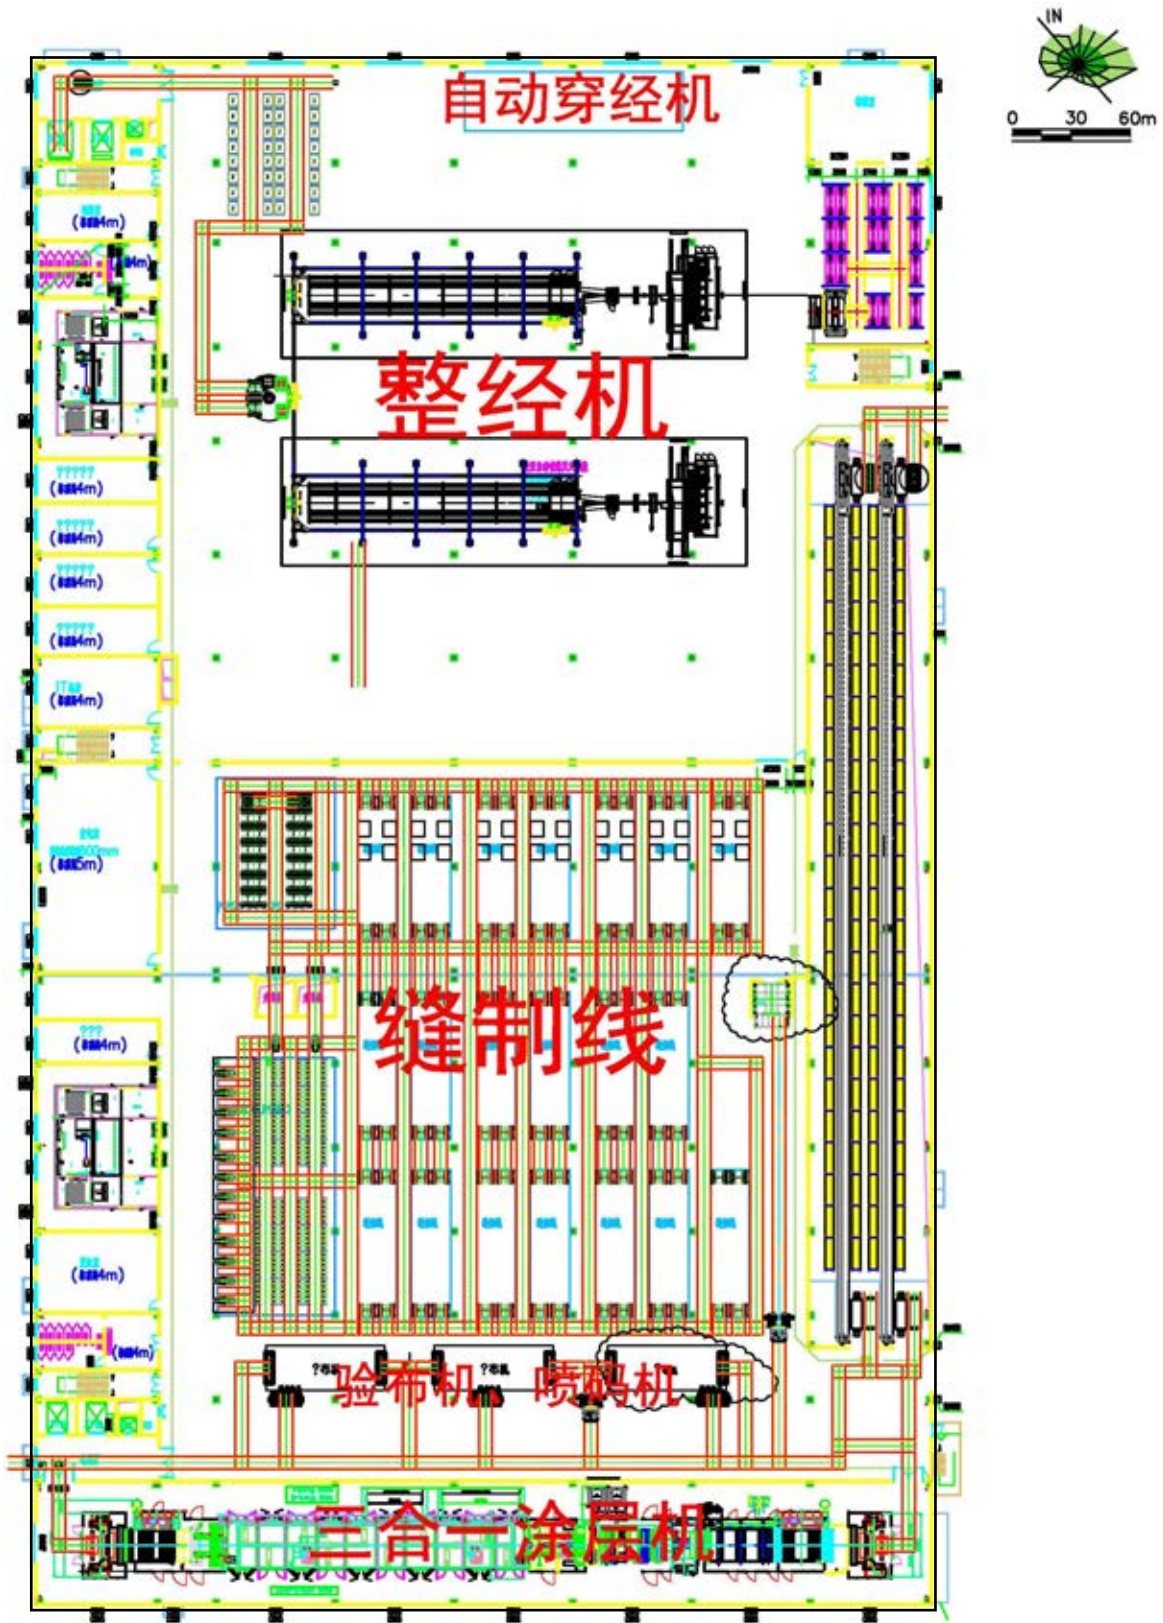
本项目生产大楼二层生产车间平面布置图
